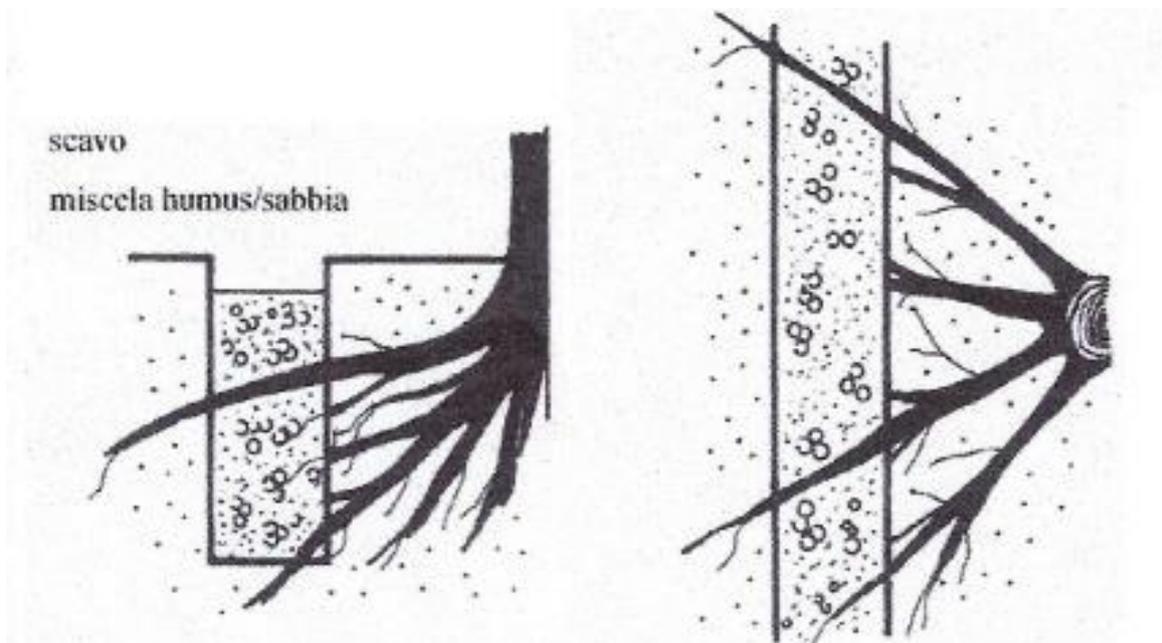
Ilustração do preenchimento das escavações junto das raízes.
